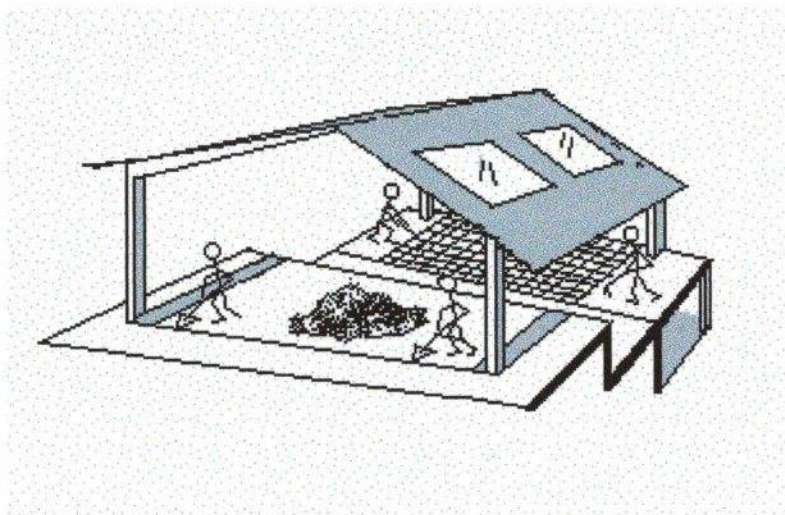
Segunda concepção construtiva do módulo RECEPÇÃO – CROQUI (ver Figura 9.40).
